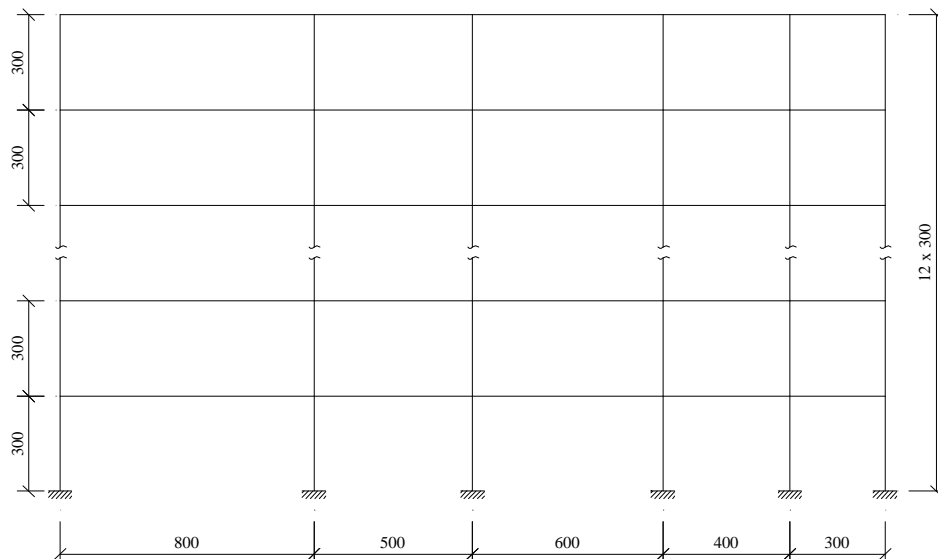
Pórtico composto de doze pavimentos e seis pilares
